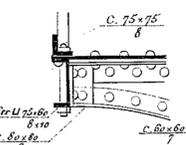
(Ech. 1/200) Coupe suivant mn. (Fig. 1).
